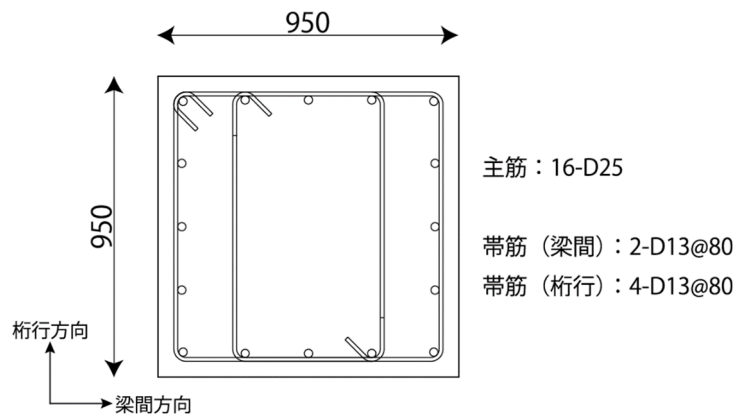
X4Y2 柱断面図（単位：mm）
